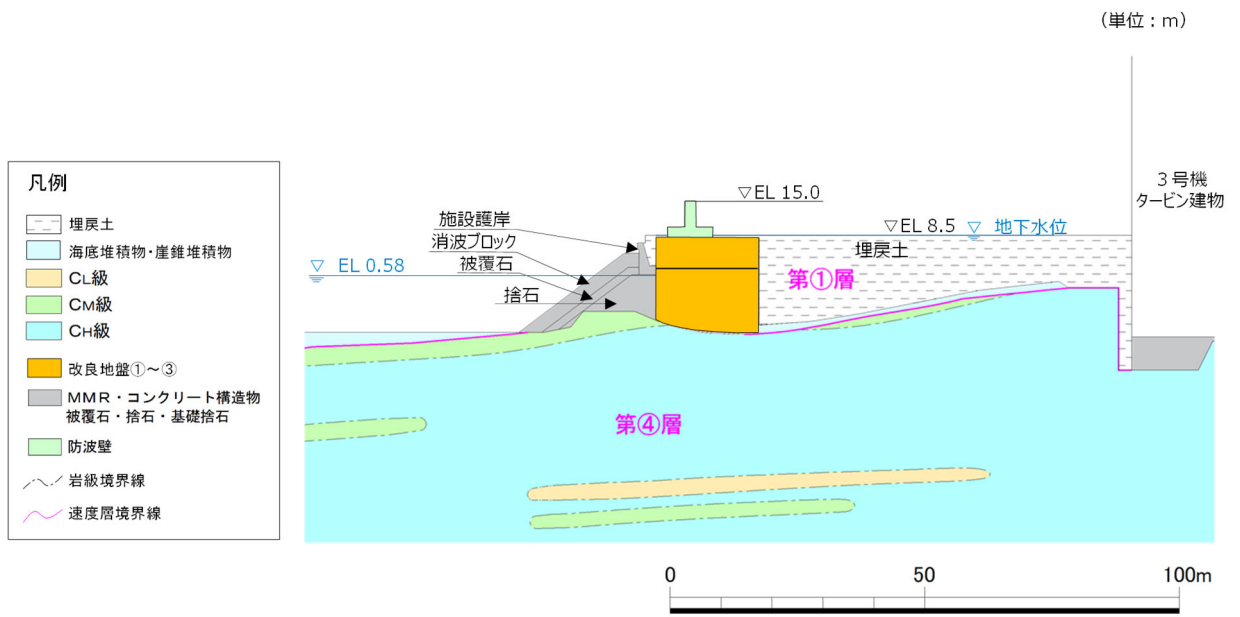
防波壁（逆 T 擁壁）の横断面図（⑤-⑤断面）
